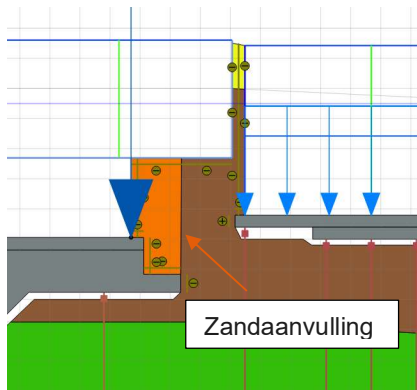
Belastingen View II hoogbouw, zie Bijlage D voor grote weergave.
